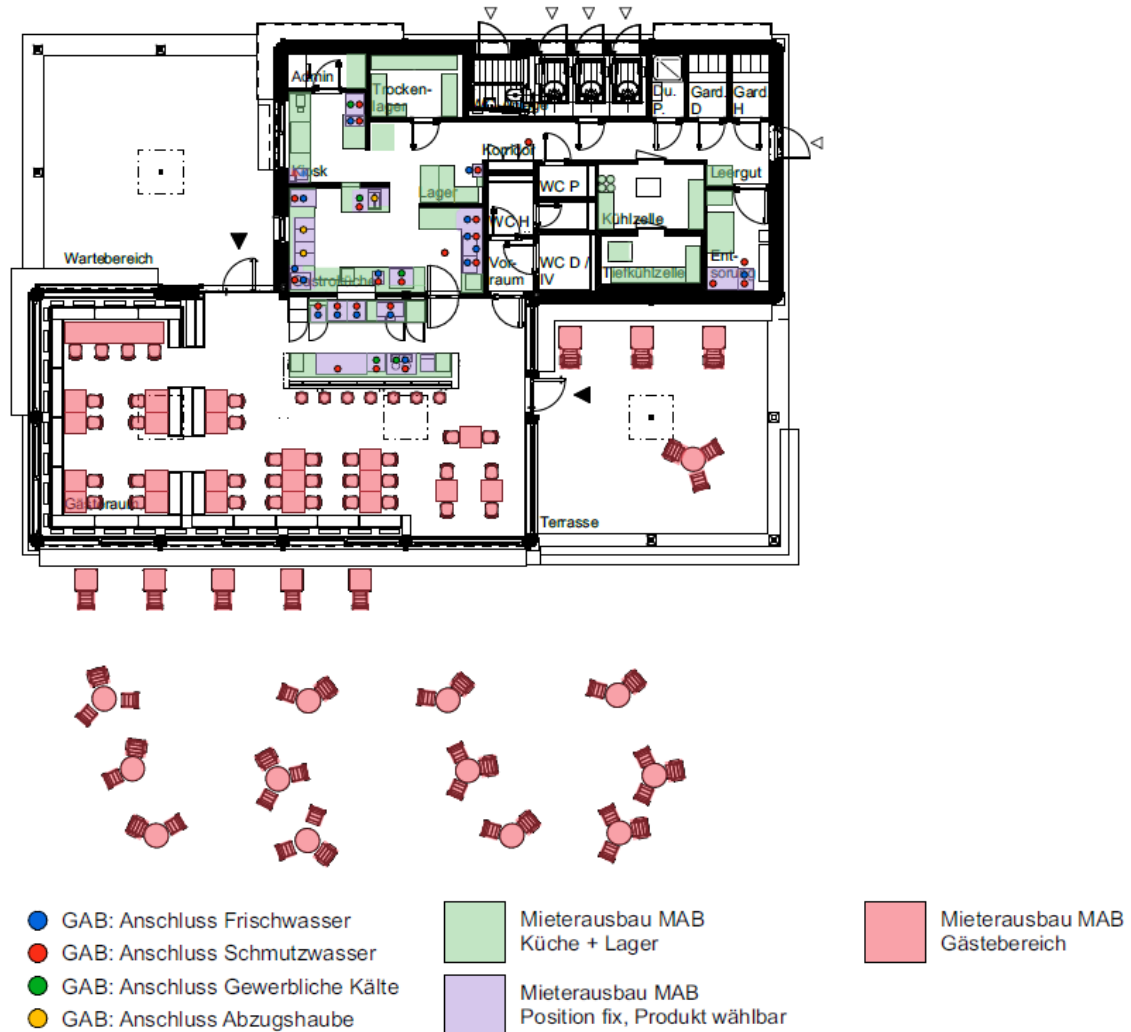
Kostenschnittstelle Grundausbau (GAB) - Mieterausbau (MAB)
